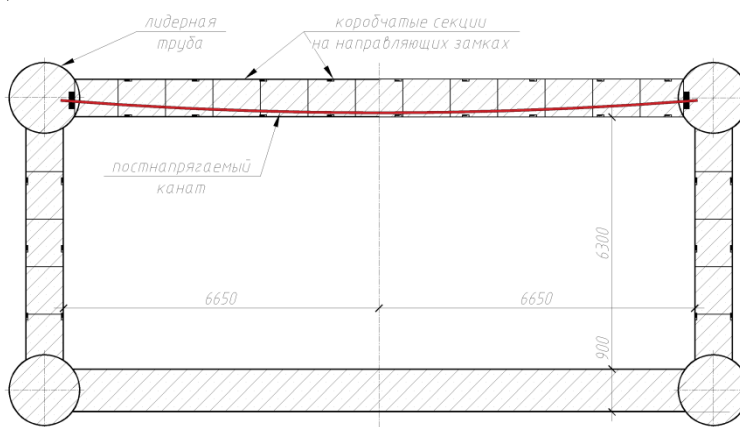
Поперечное сечение плитного опережающего перекрытия с постнапряжением, устраиваемым из лидерных труб.
